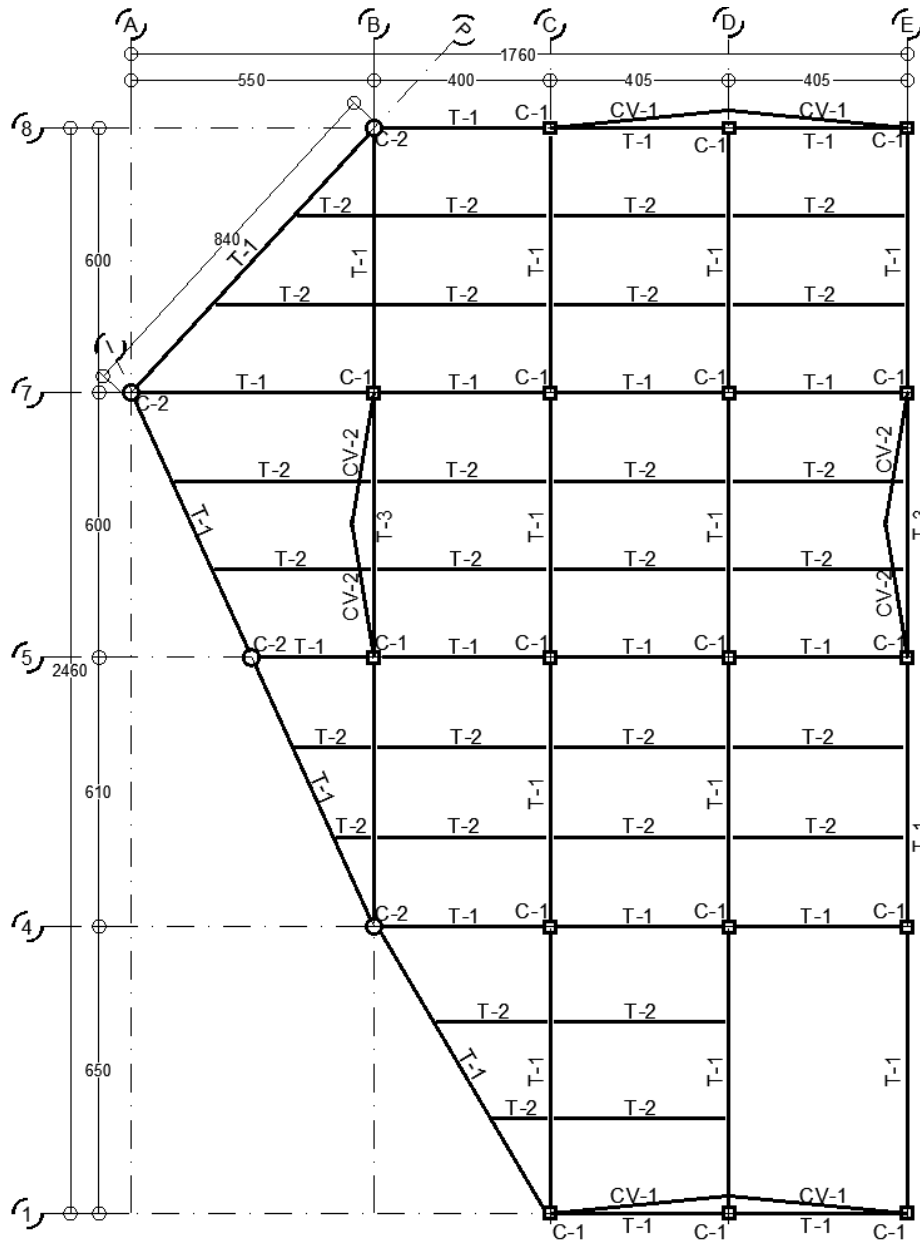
Esquema de la planta estructural tipo - propuesta 1
